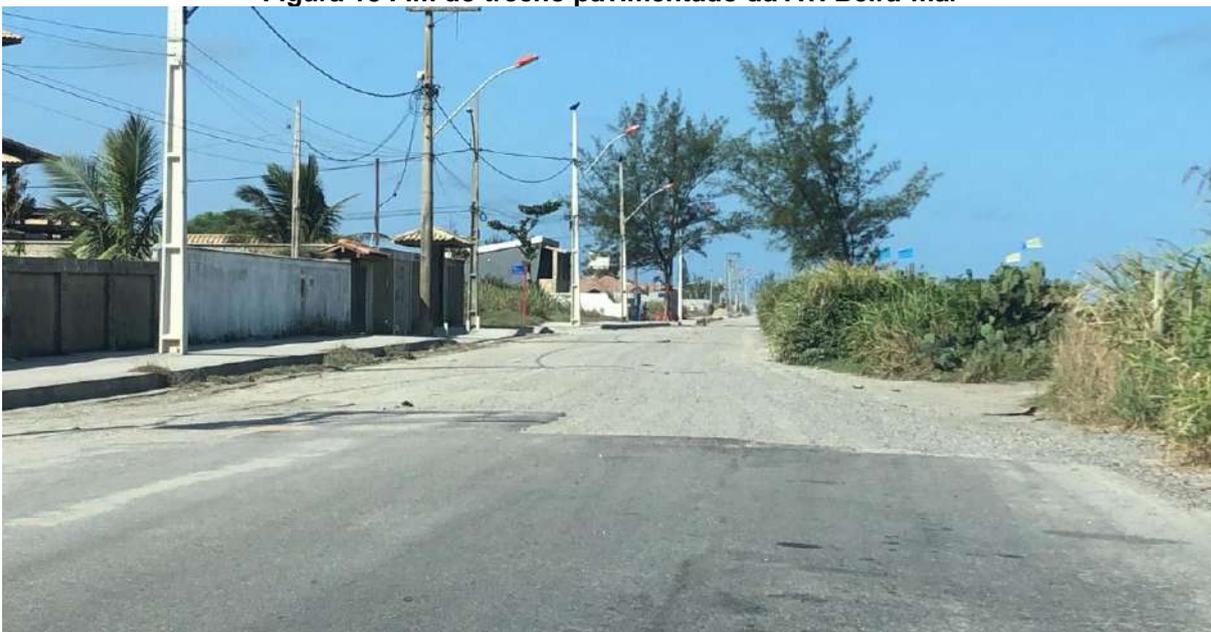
Fim do trecho pavimentado da Av. Beira-mar
